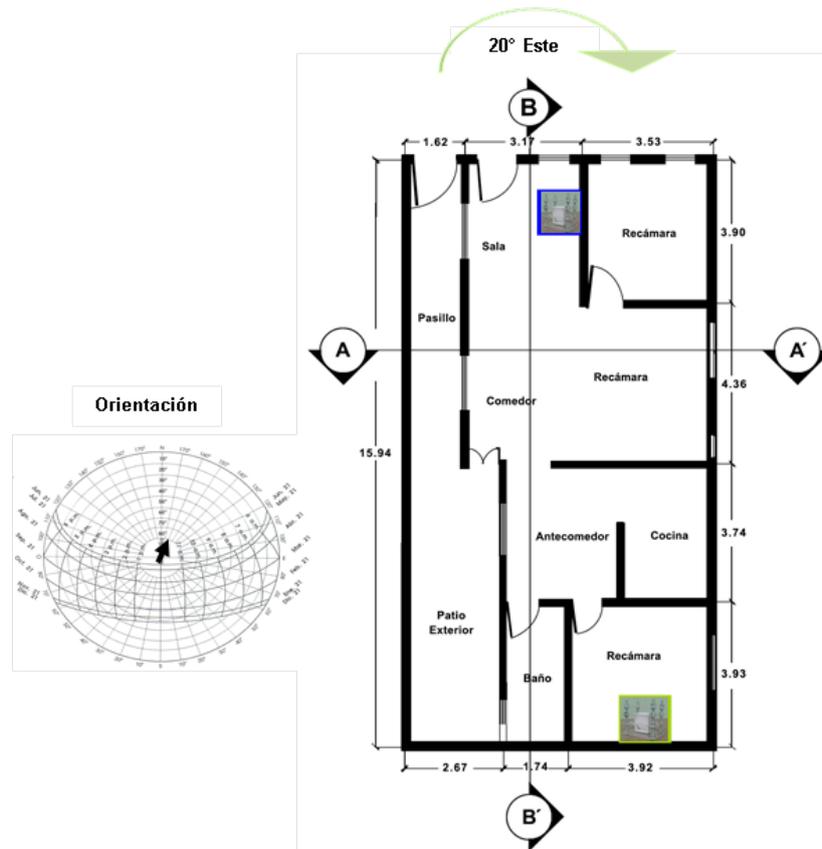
Planta arquitectónica de la vivienda típica tradicional.
